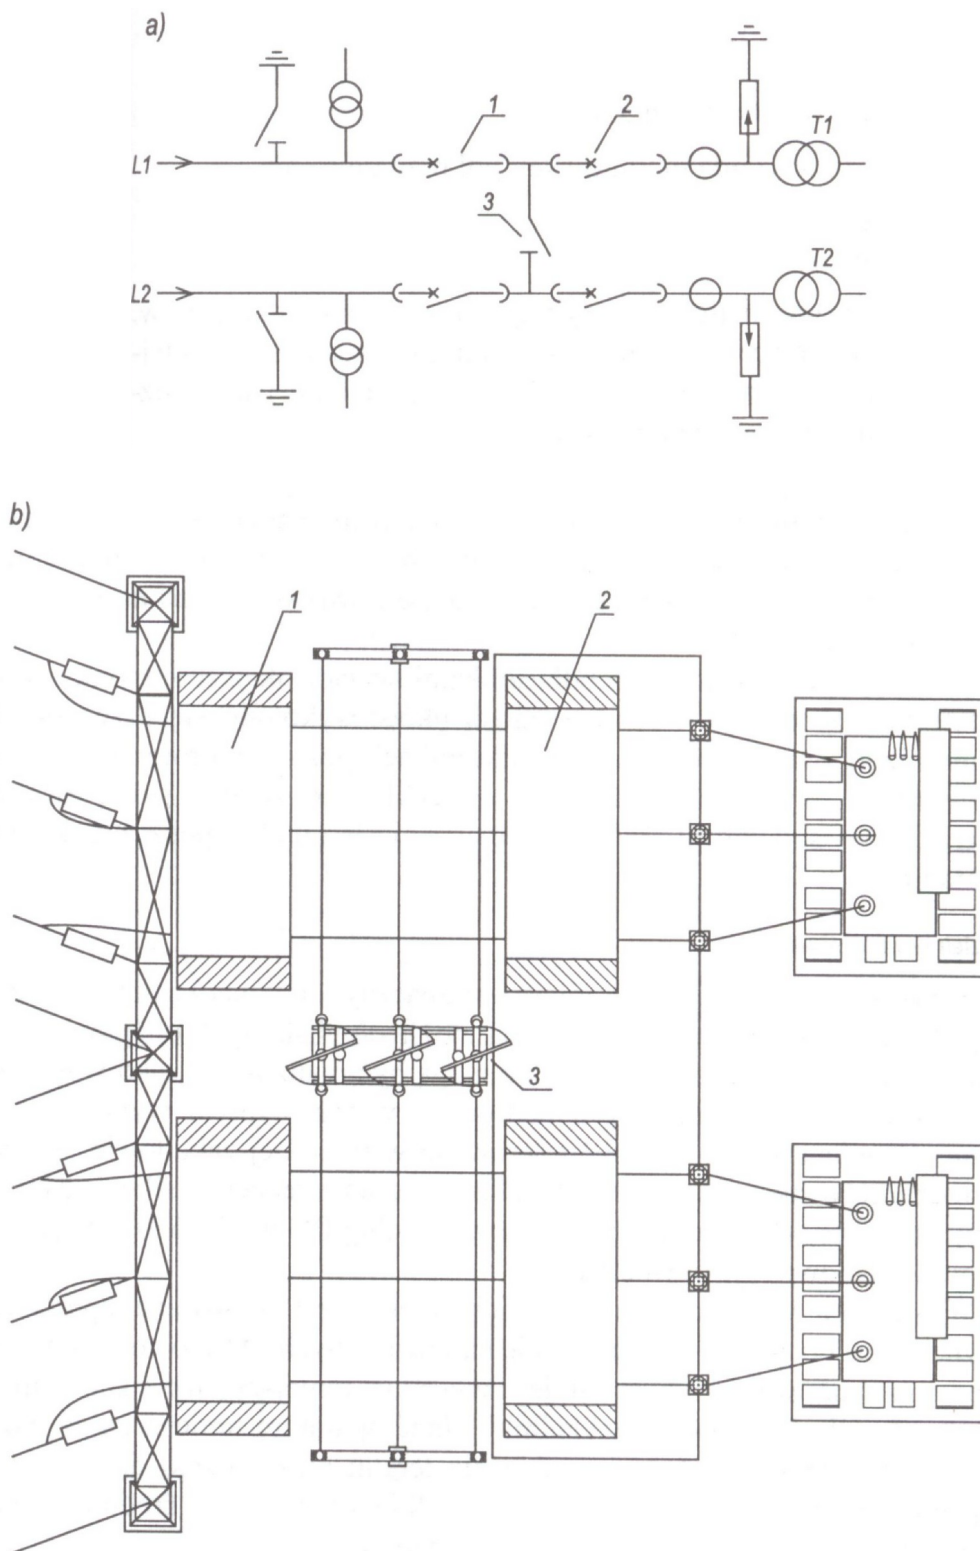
Przykładowe konstrukcje pól rozdzielni z SF₆ typu 8D.2 firmy Siemens na napięcie znamionowe 123÷170 kV
